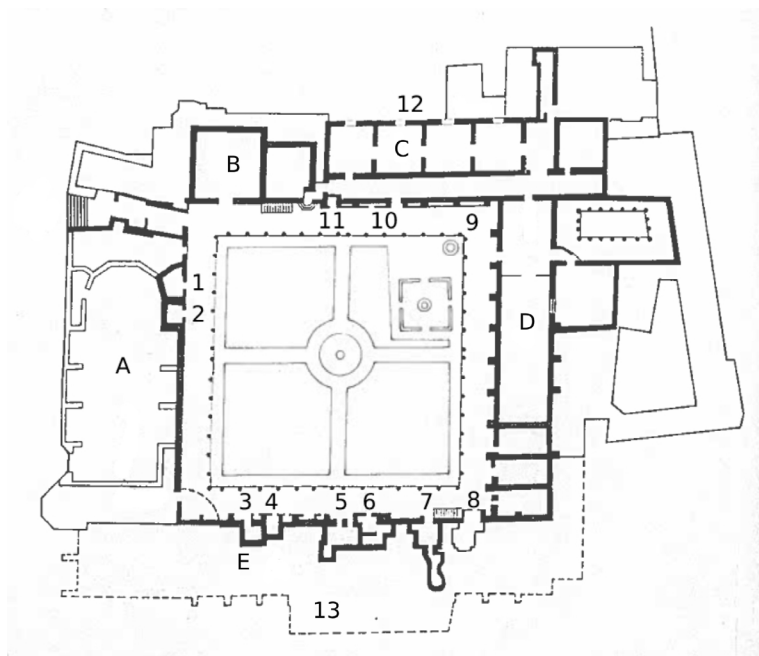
Monasterio de Pedralbes. Esquema de la planta baja del conjunto
